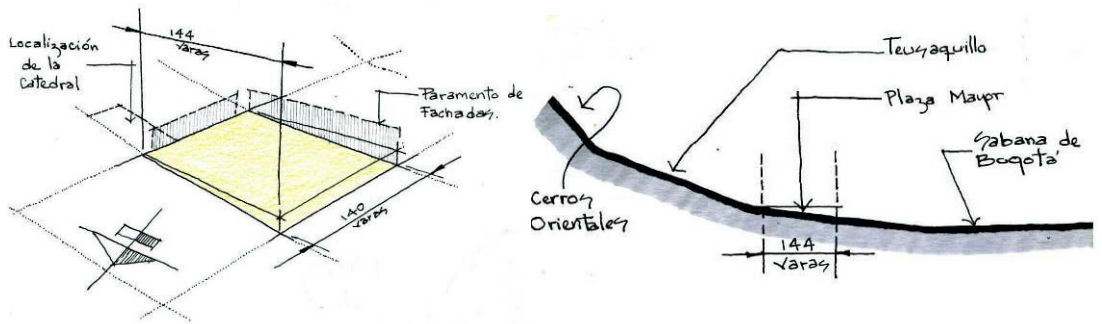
Plano inclinado de la Plaza Mayor. Perspectiva y sección.
